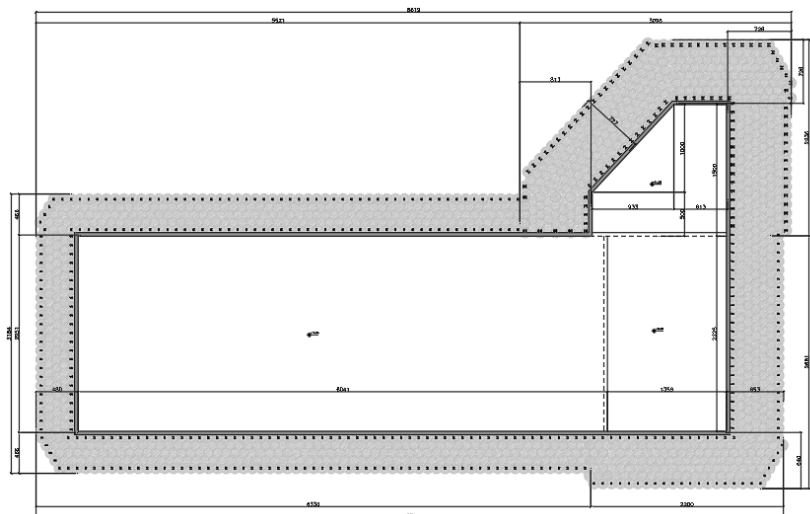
Planta baixa EL:3,00m, Conteção perimetral
